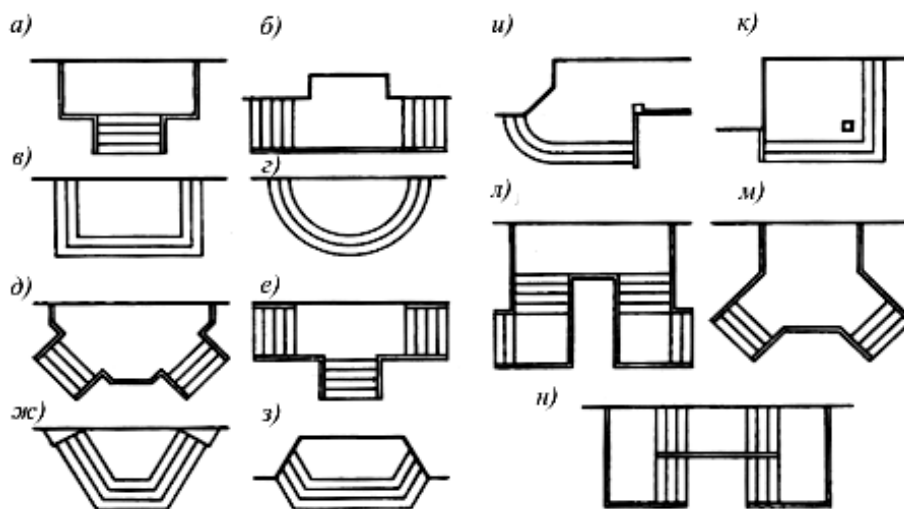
Планировочные схемы входных лестниц жилых зданий
